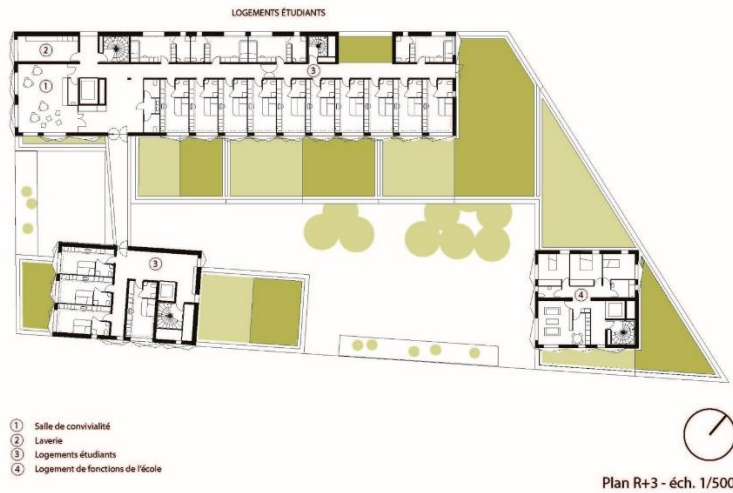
Planta arquitectónica, fuente: Archidaily.com
